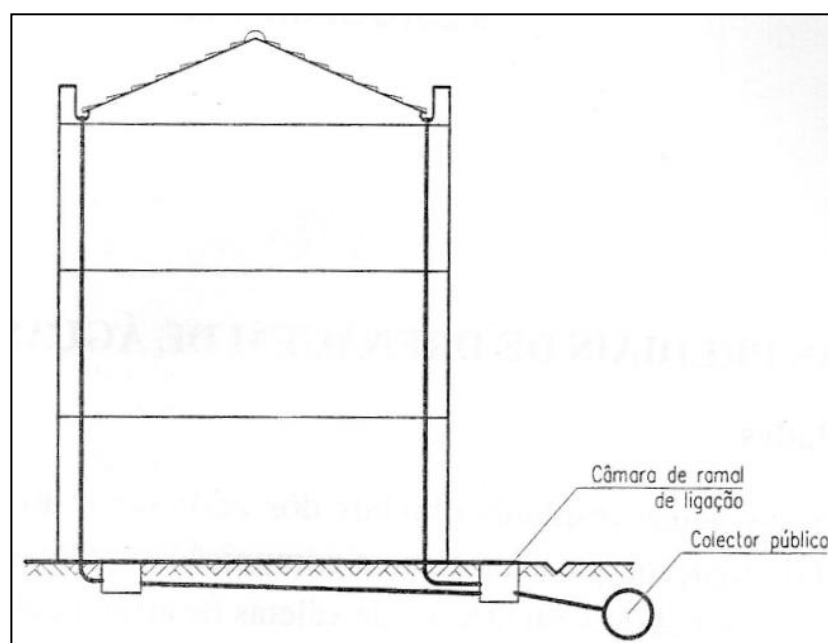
Constituição de um Sistema de Drenagem de Águas Pluviais, [3]
